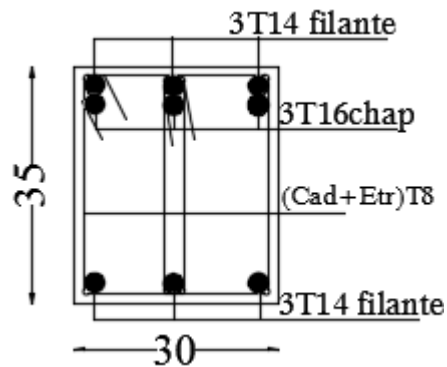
Ferrailage sur appuis d'une poutre secondaire.
